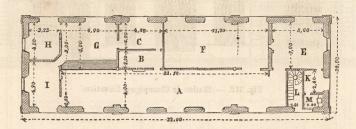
110 classe. Plan du rez-de-chaussée.
